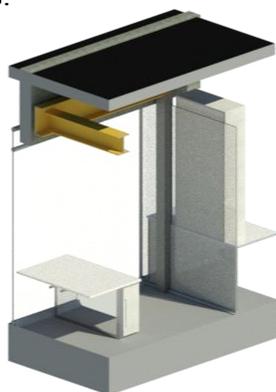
PTR como elemento constructivo en laboratorio de restauración.
